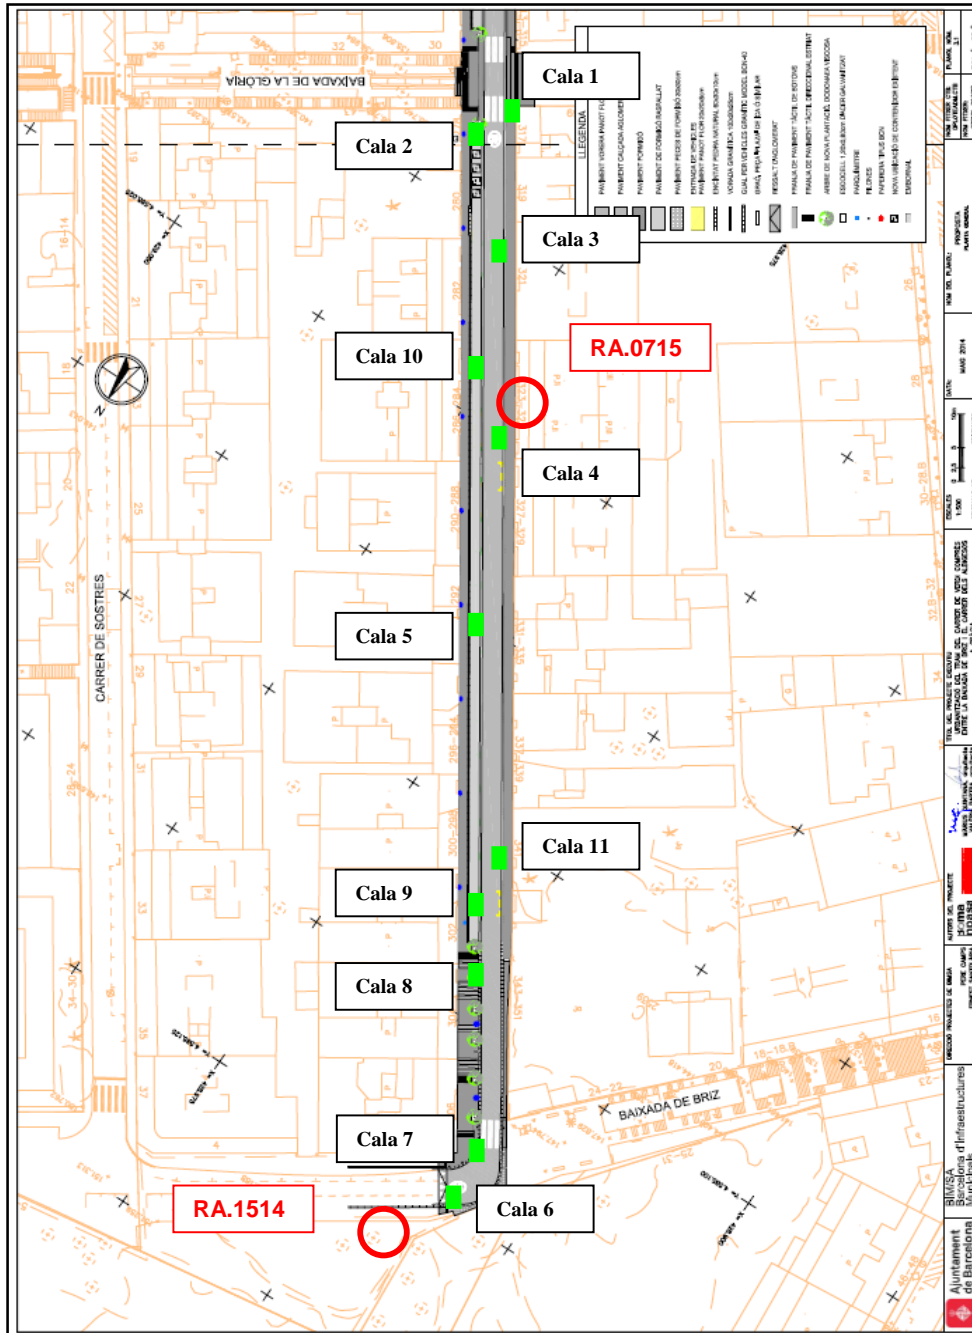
Planimetria facilitada per Ajuntament de Barcelona-Servei d'Arqueologia de Barcelona.
